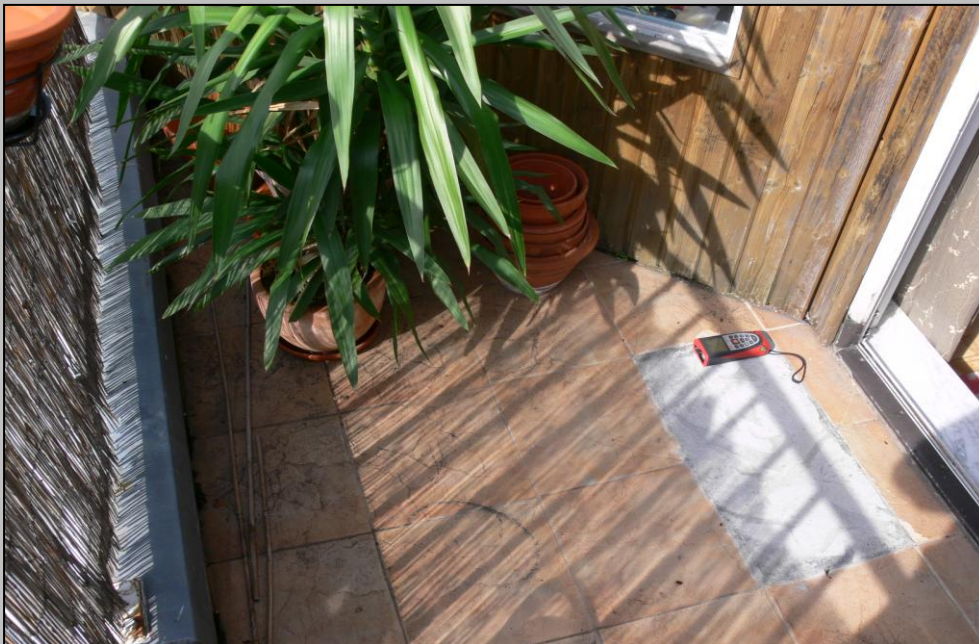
Fliesenbelag, darunter schadhafte Abdichtung
